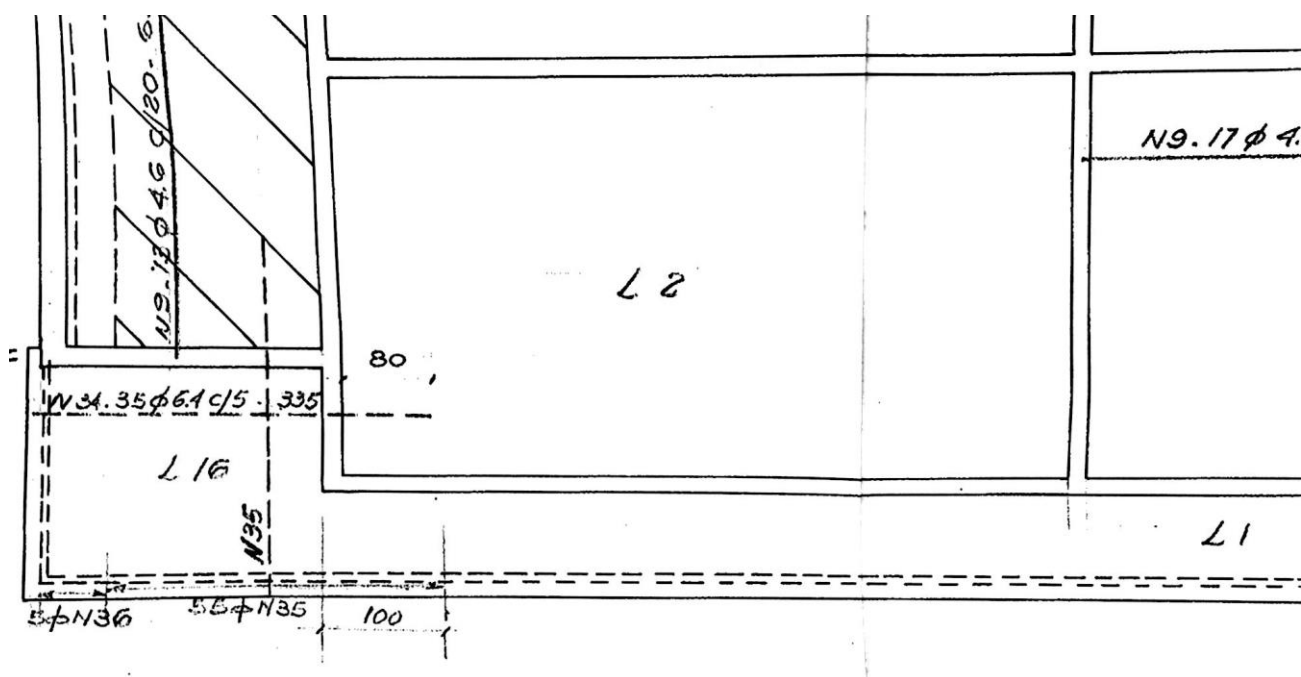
Projeto Estrutural - Armação das lajes Fundação - Det. Ampliado
